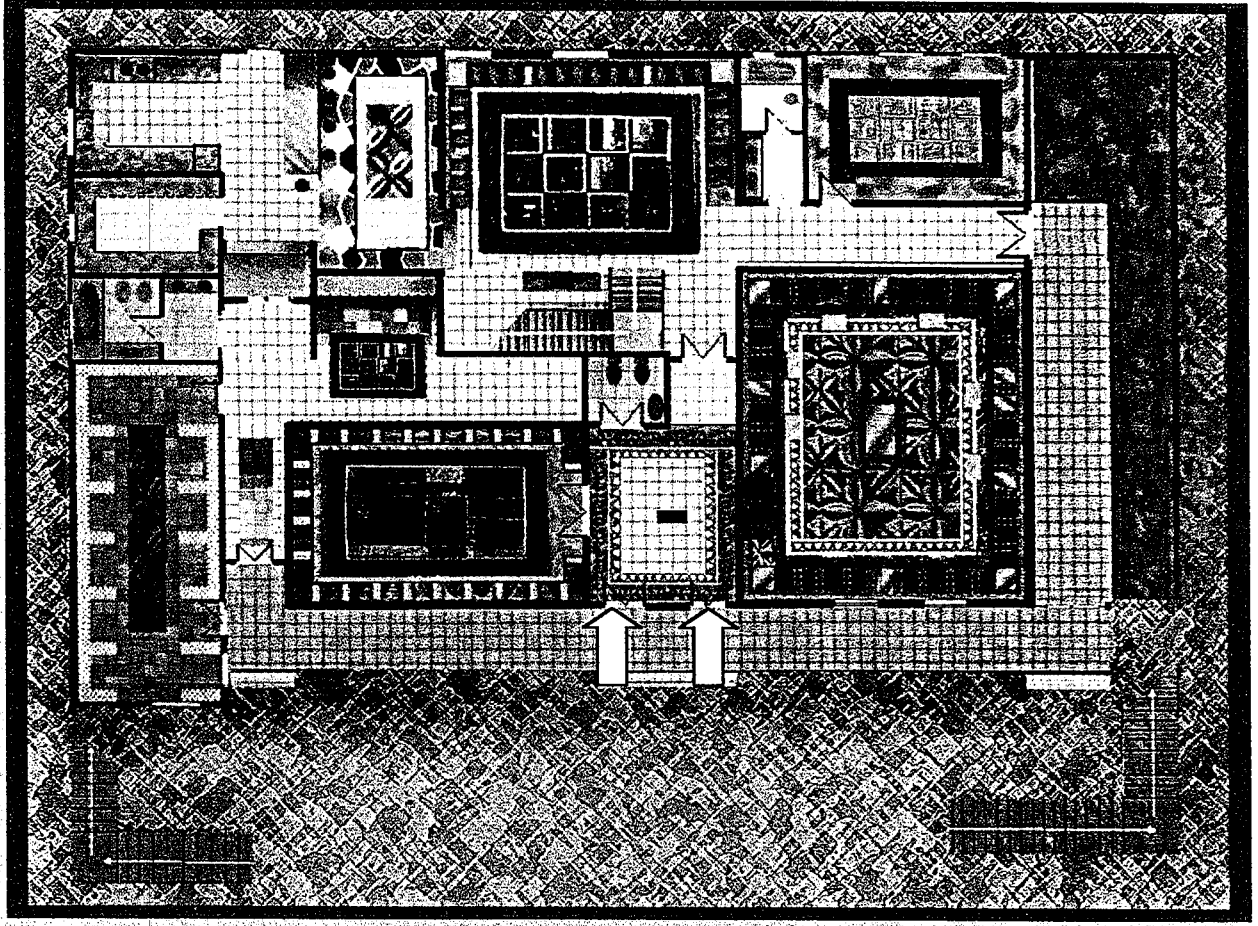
مسقط أفقي للدور الأرضي (نموذج رقم ٣)
